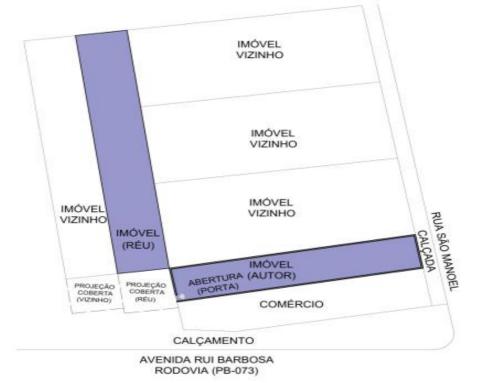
Planta com a indicação da abertura da porta proposta pelo o autor
